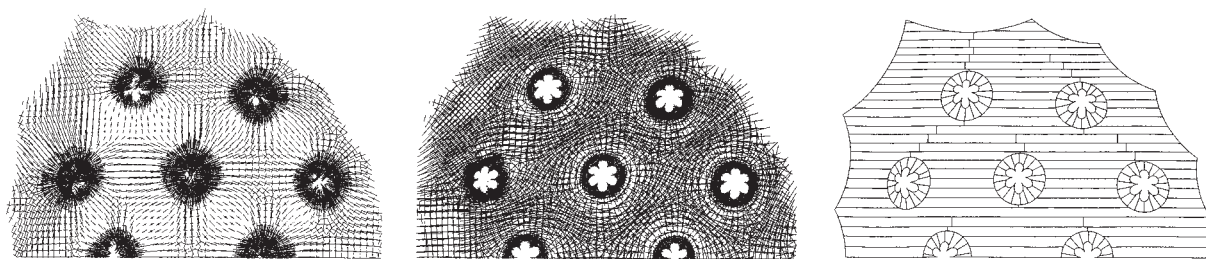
Hauptspannungen und Bahnenlayout einer Schwimmbadüberdachung in Malaysia
